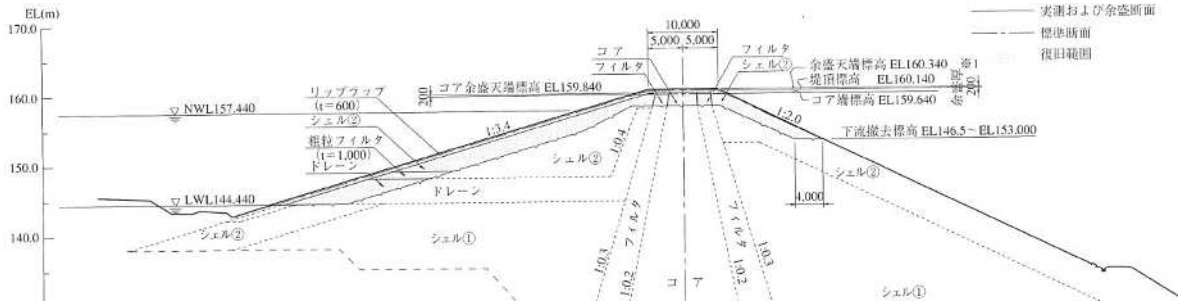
山本第二調整池復旧(補修)横断面図
